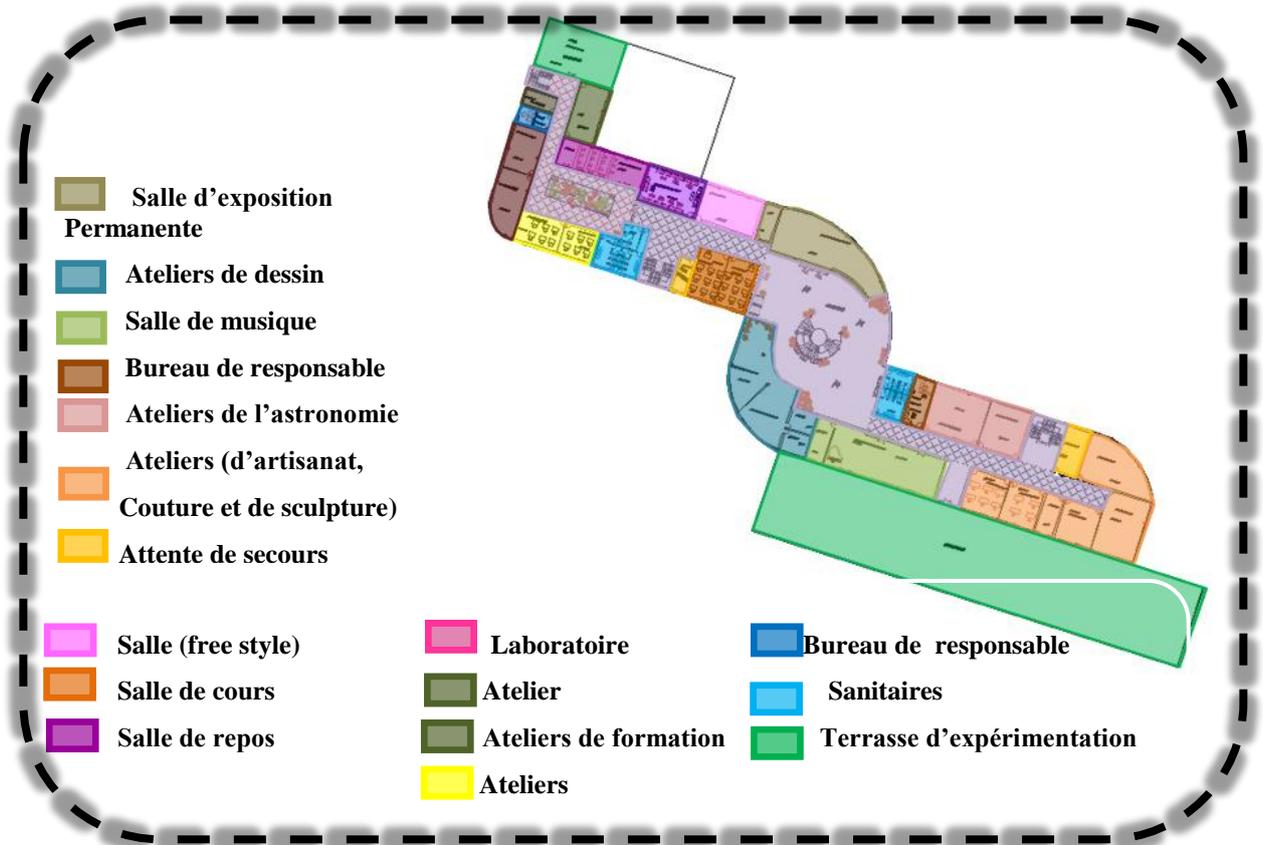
Plan du 2<sup>ème</sup> étage
